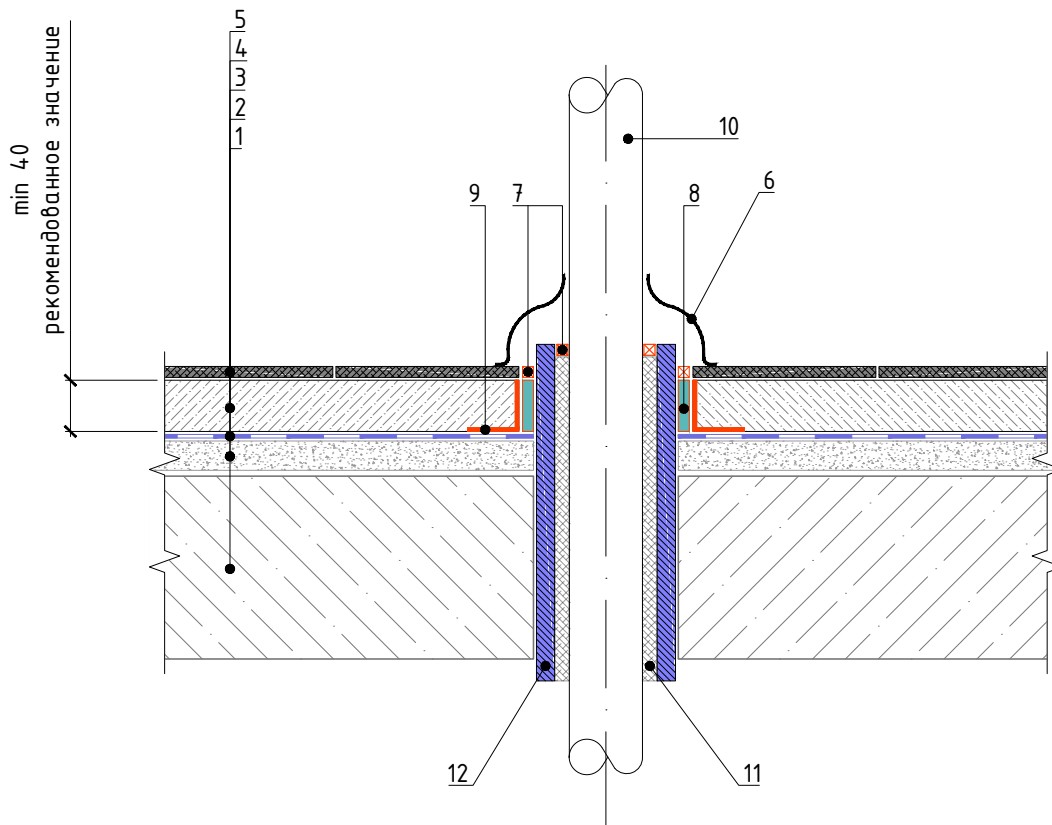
Схема конструктивного решения узла пропуска стояка отопления через междуэтажное перекрытие
